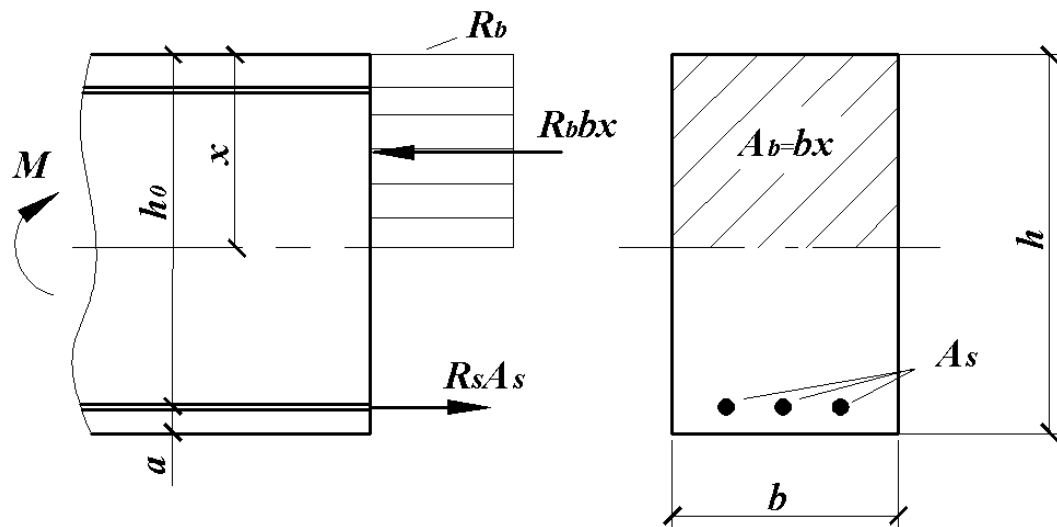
Прямокутний переріз з поодинокую арматурою і схема зусиль
